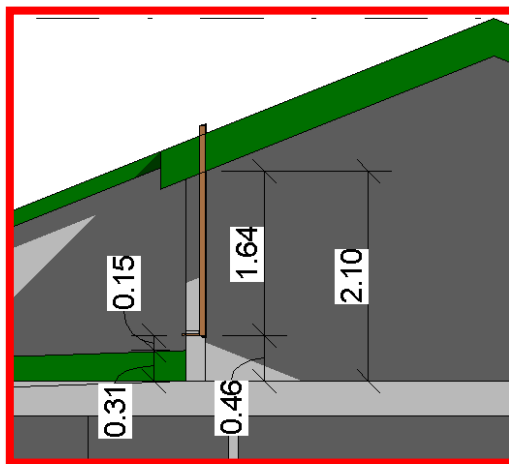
Colocación de la carpintería de acceso a cubierta plana. 2014. Elaboración propia
